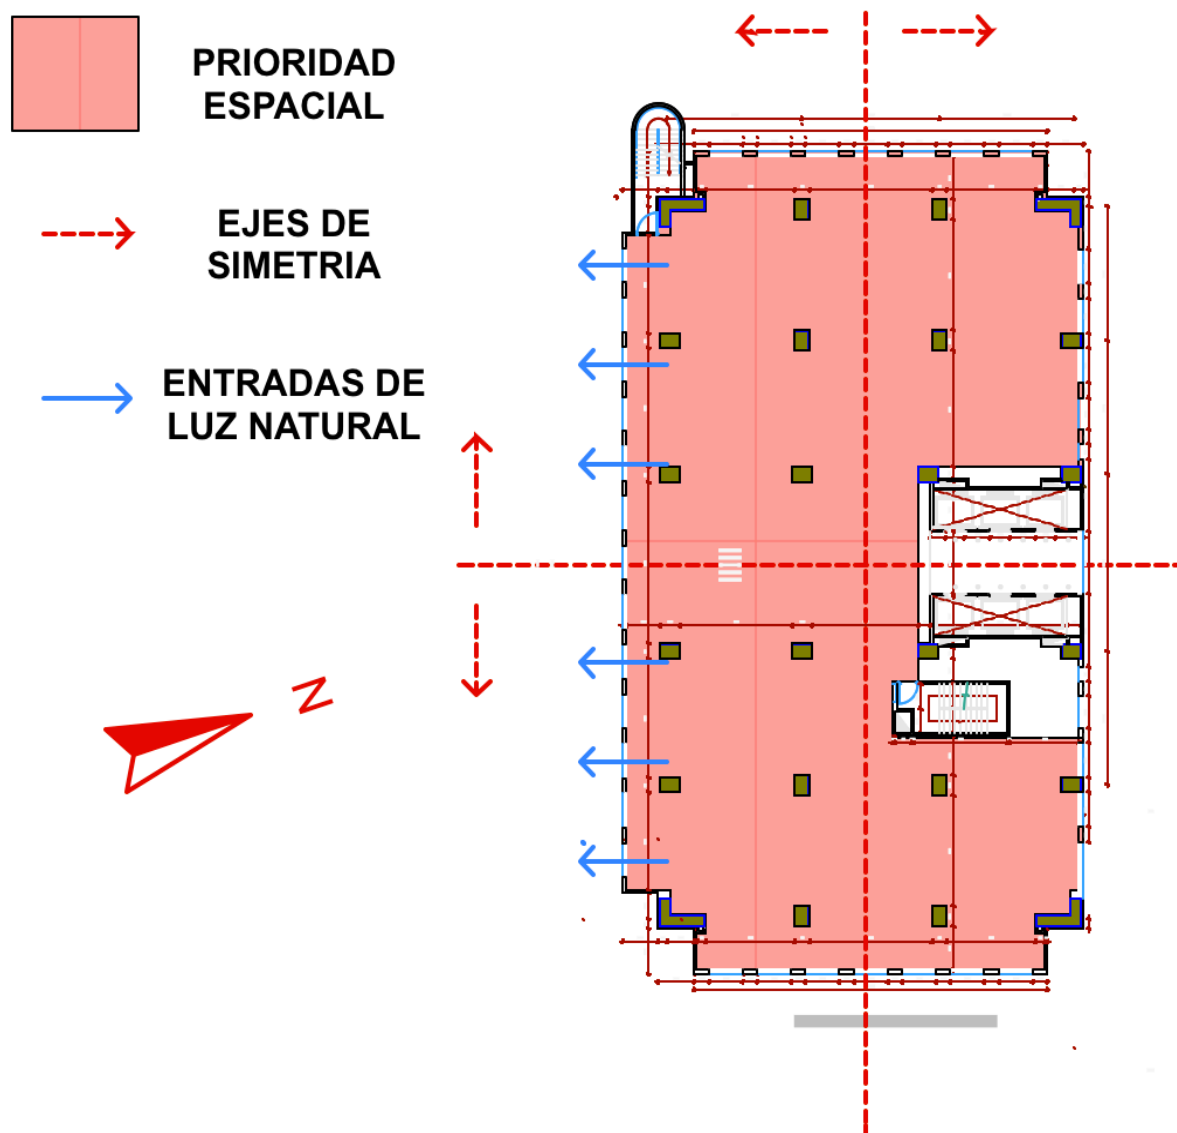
Planta Oficina Abierta, Edificio Capital Tower
